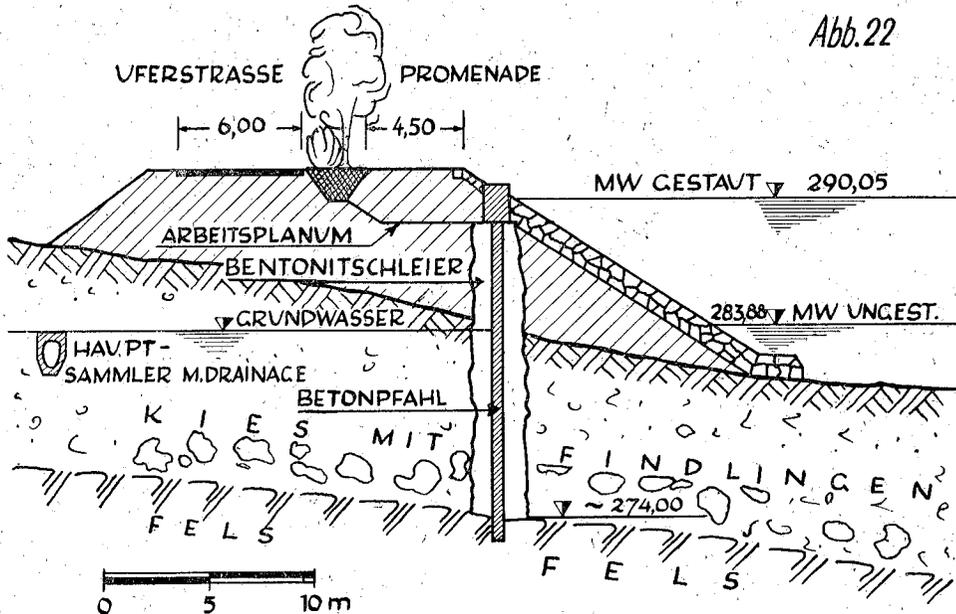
Regelquerschnitt für die Dichtungswand mit Orthbetonpfählen
